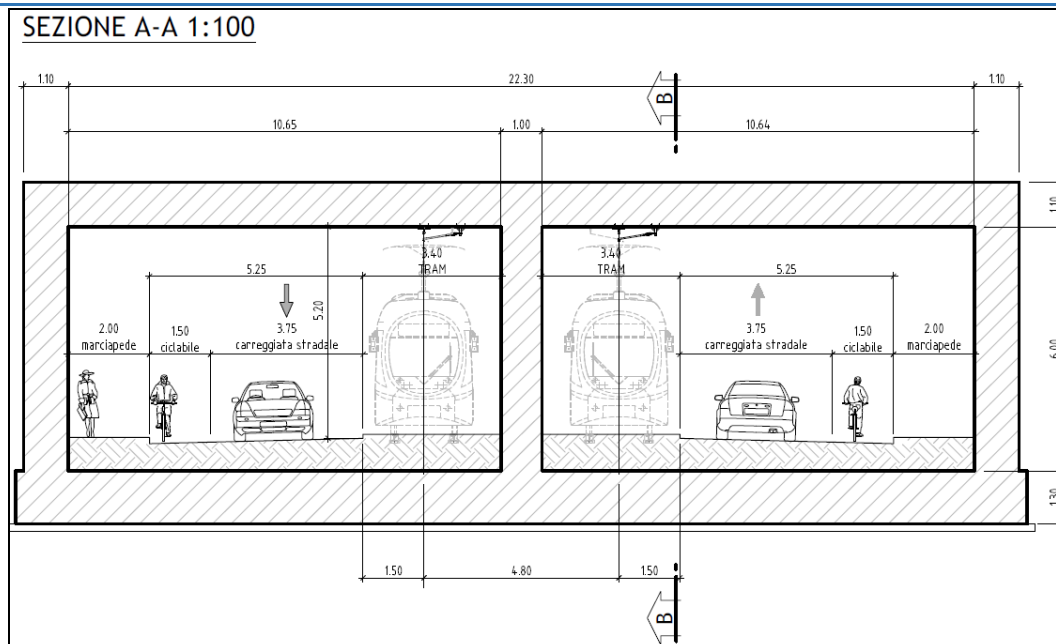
Sezione trasversale sottoattraversamento (estratto da elaborato B831-C-SF-STR-RT003A)
